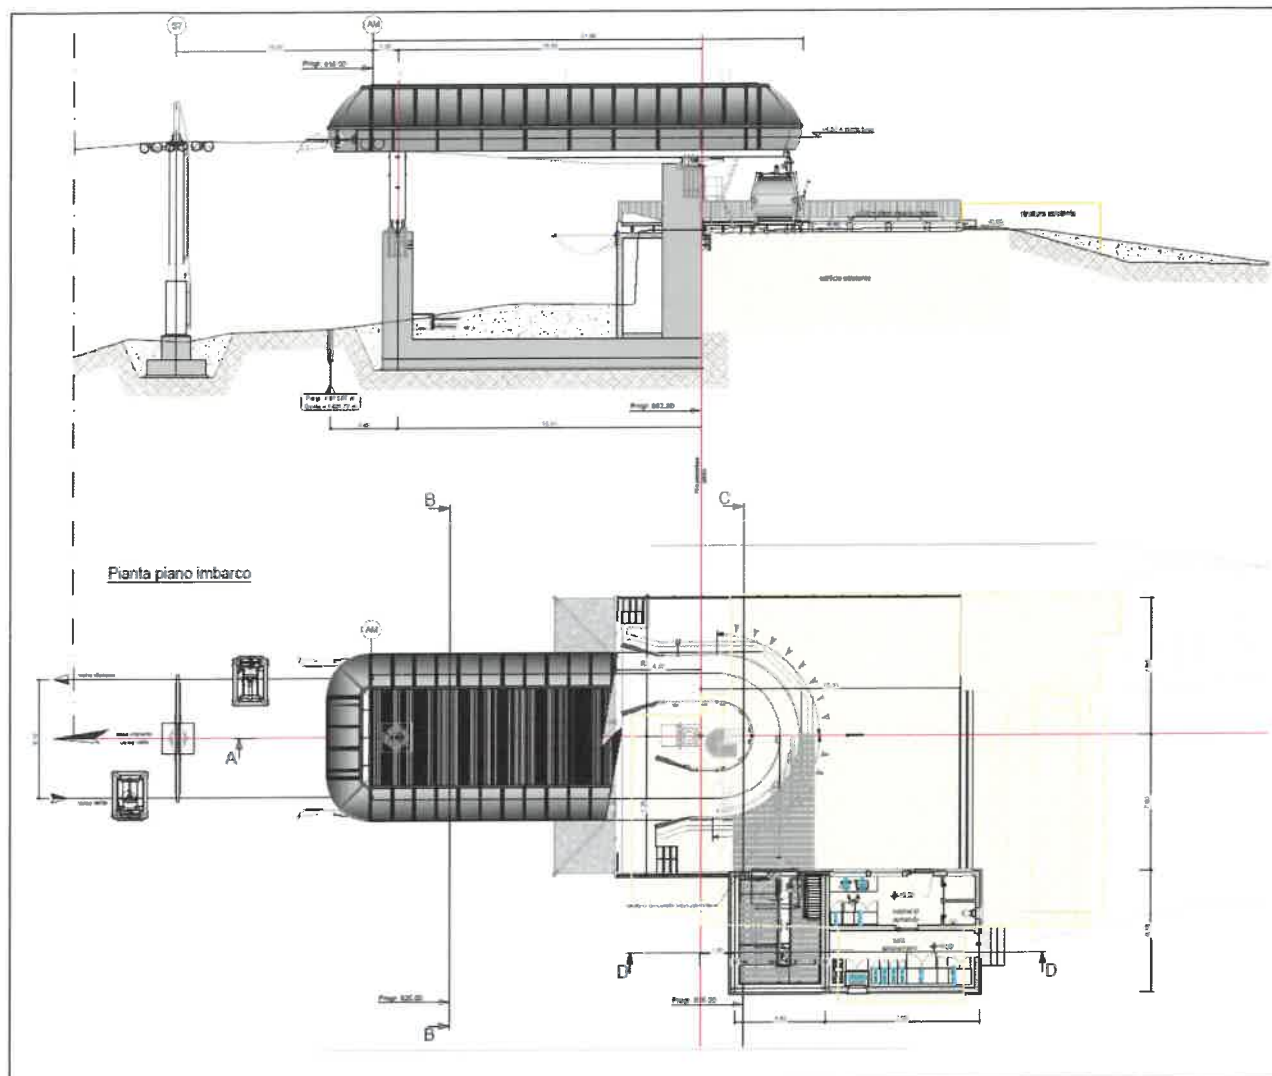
Stazione di monte: pianta e sezione (Elaborato EG15)
